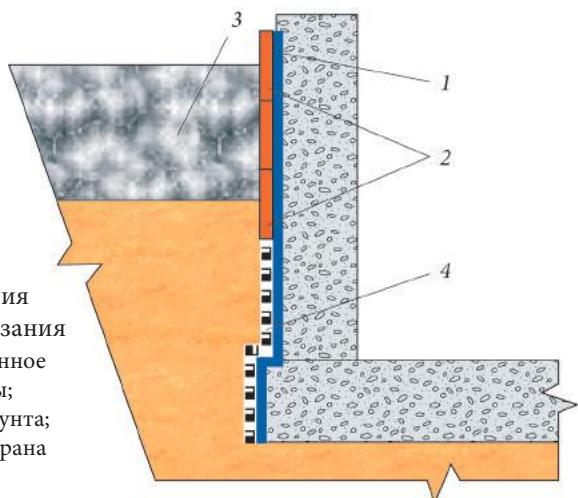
Схема утепления подвала на глубину промерзания грунта: 1 — гидроизоляционное покрытие; 2 — XPS плиты; 3 — глубина промерзания грунта; 4 — профилированная мембрана *PLANTER STANDARD
